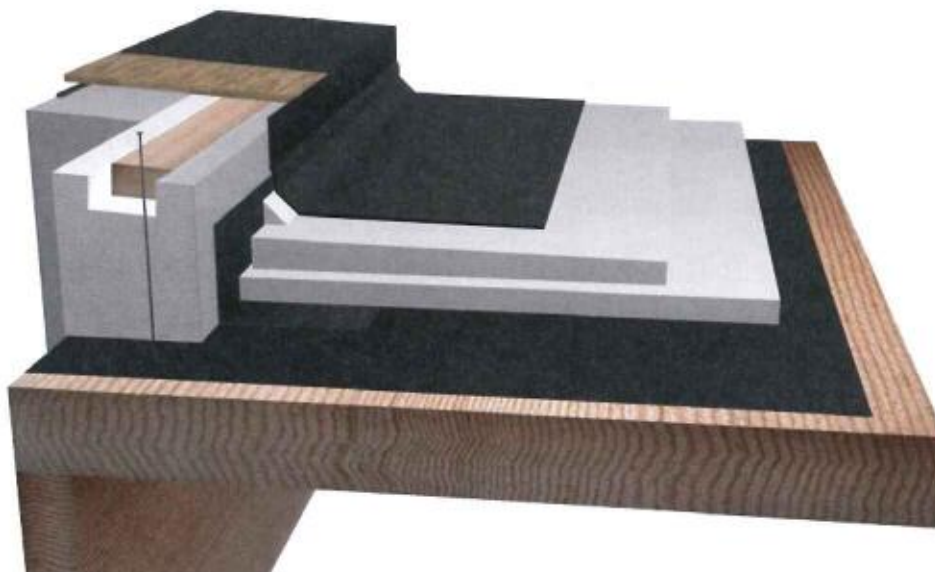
Systematische Darstellung Attika-Element Fassade auf Holzuntergrund (Massivholzdecke)
